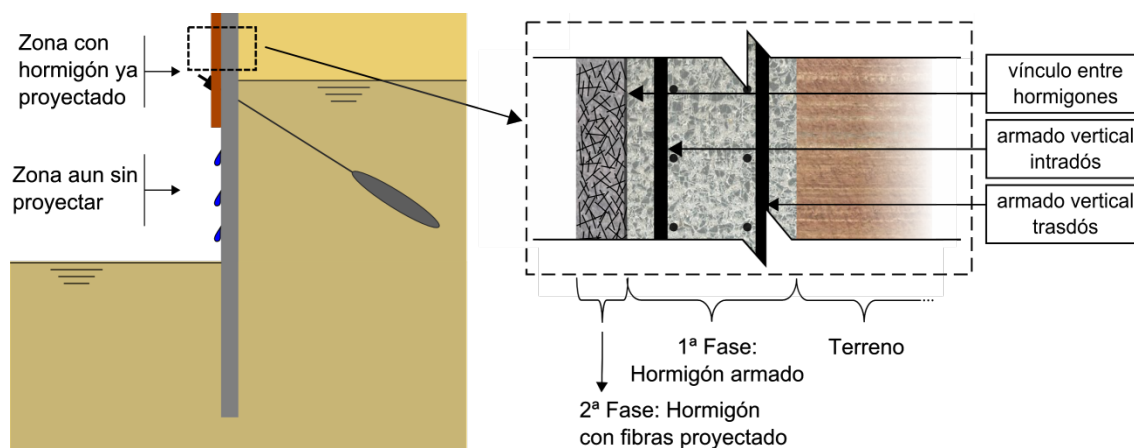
Esquema de la solución por muro Bi-Capa. Vista general y vista de una sección
